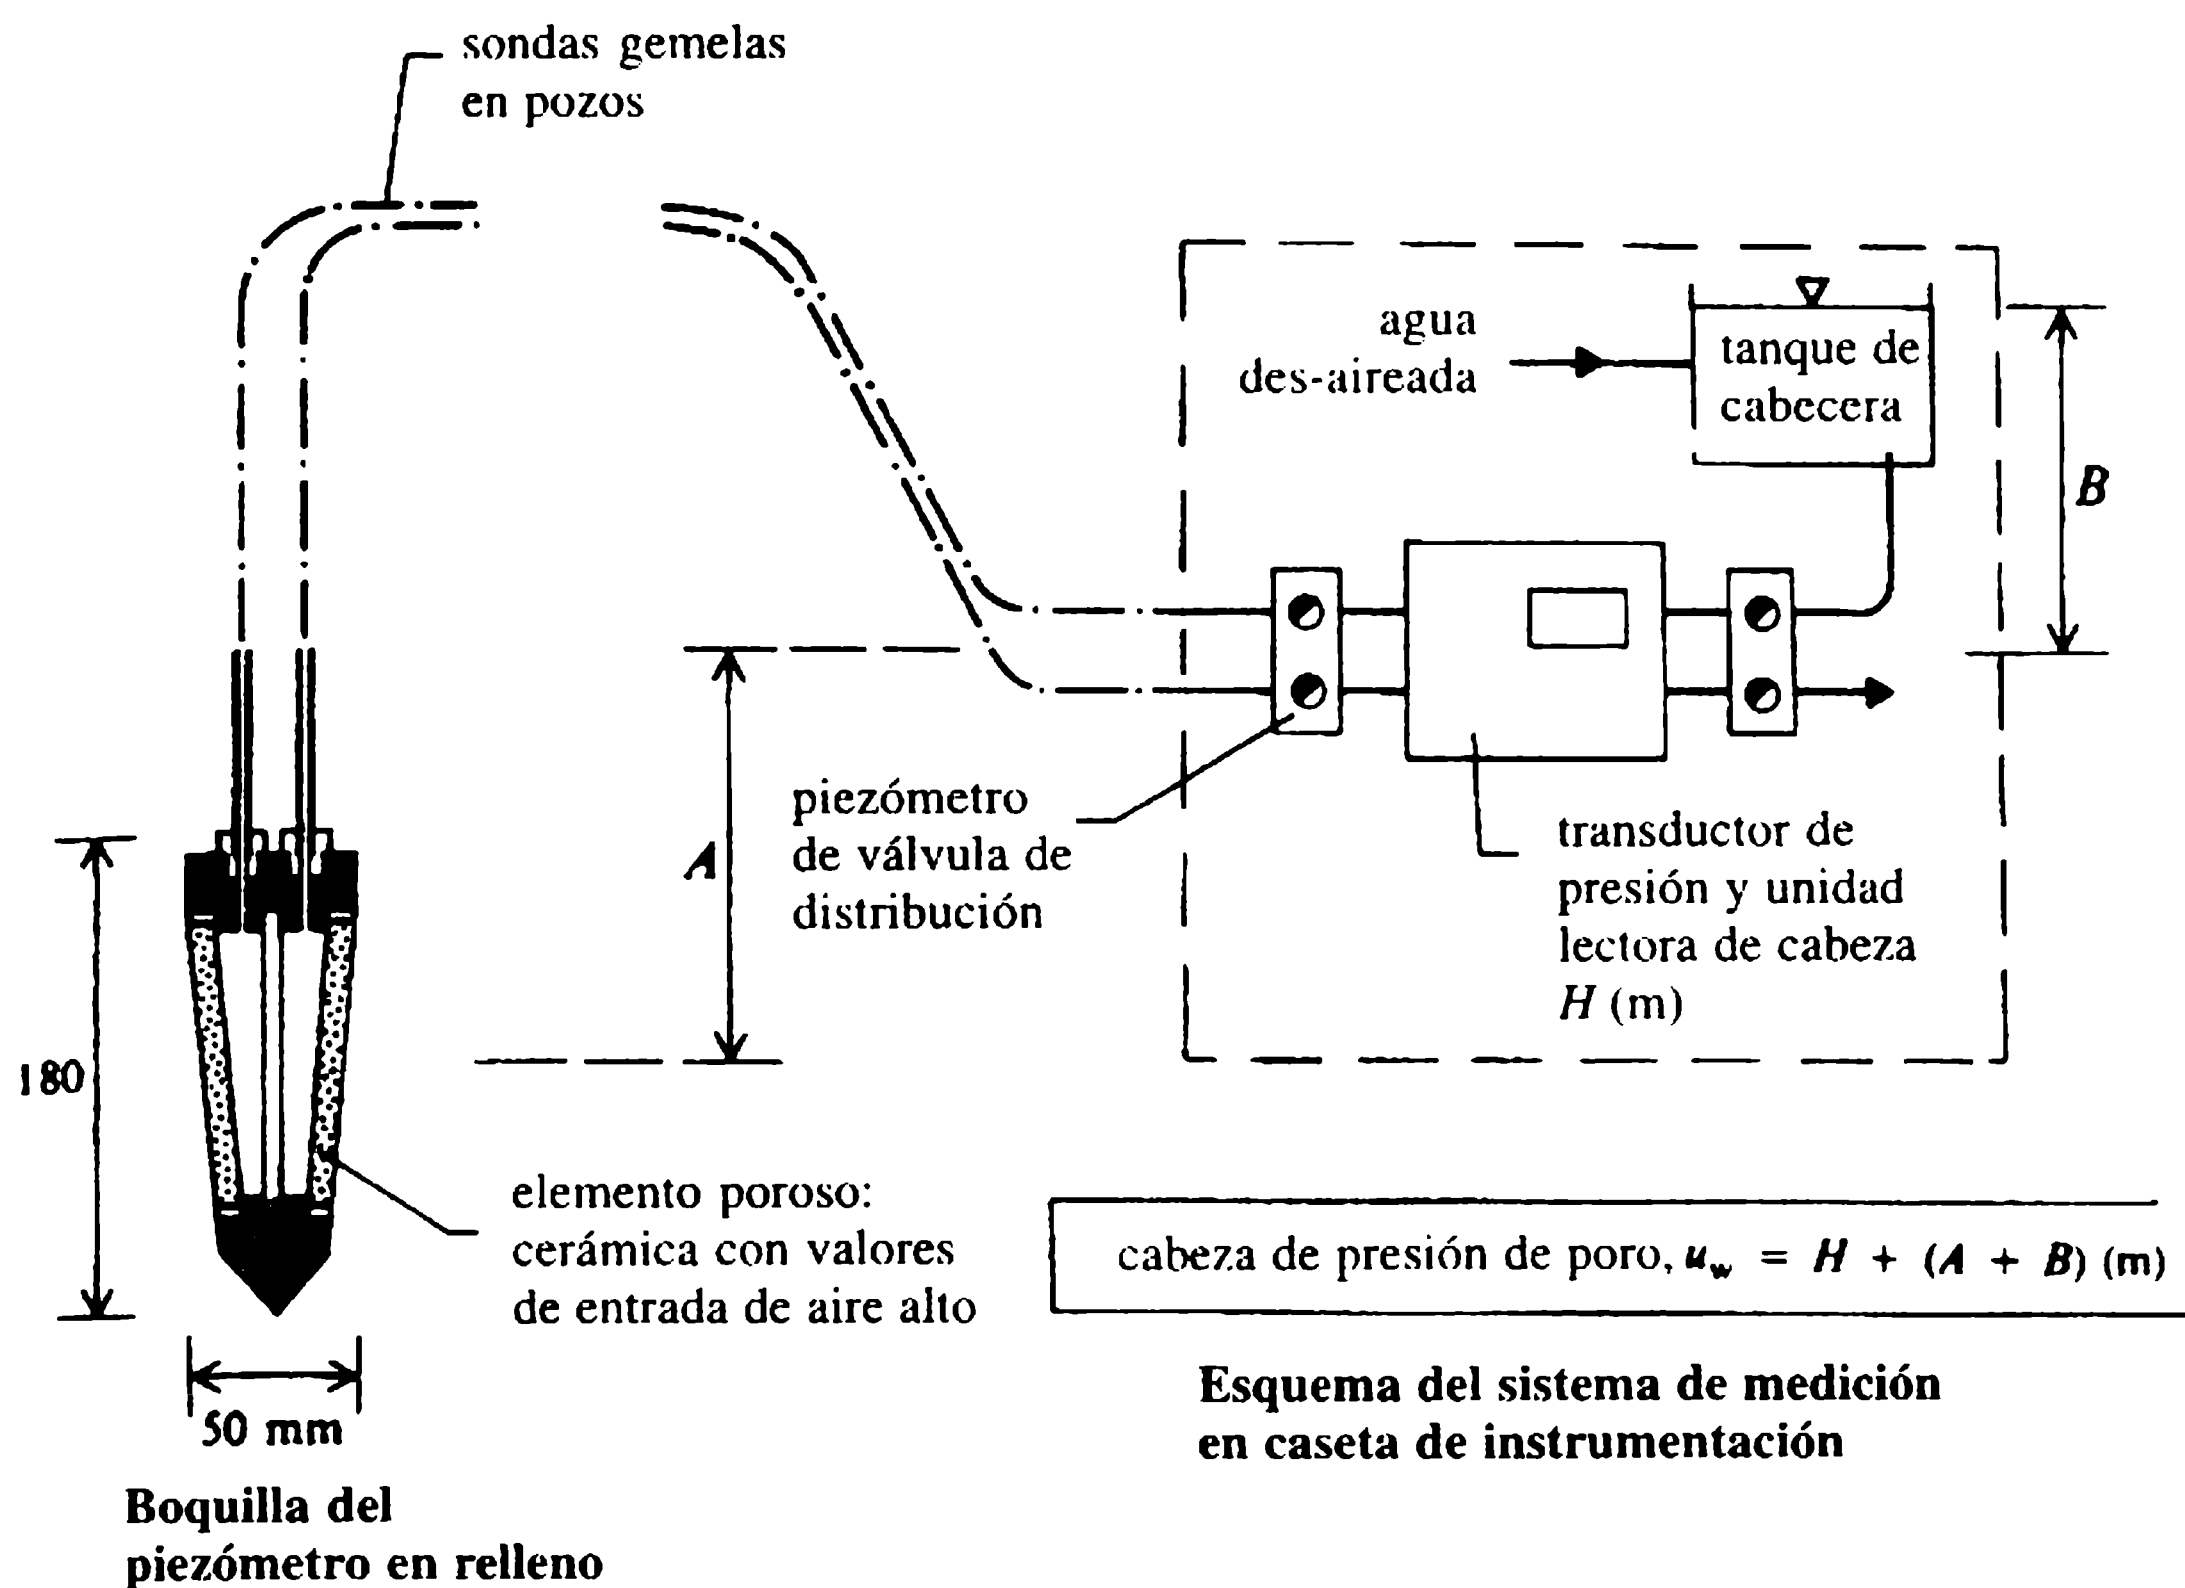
Piezómetro hidráulico de tipo Bishop de tubería gemela.
